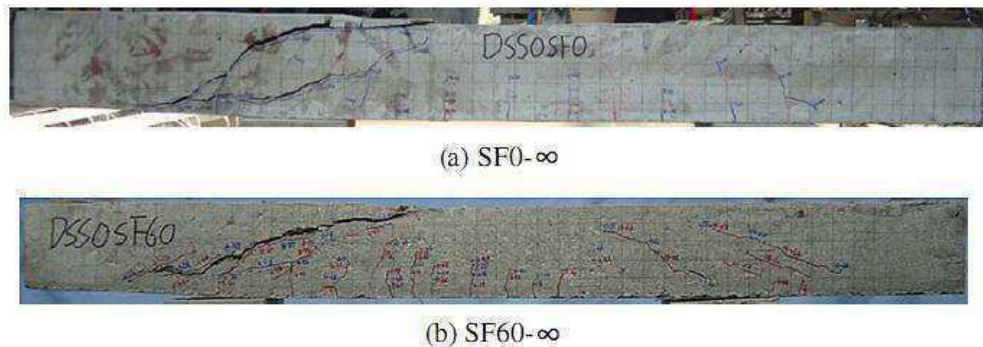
Mode de fissuration des poutres avec des fibres d'aciers sans cadres [50].
